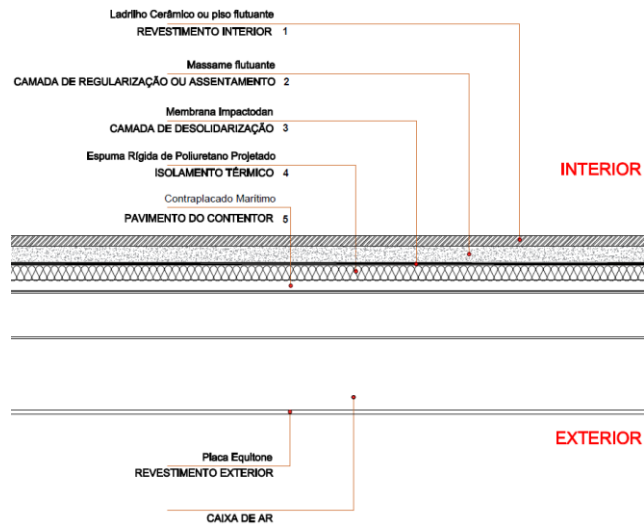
Composição do Pavimento sobre espaço exterior
